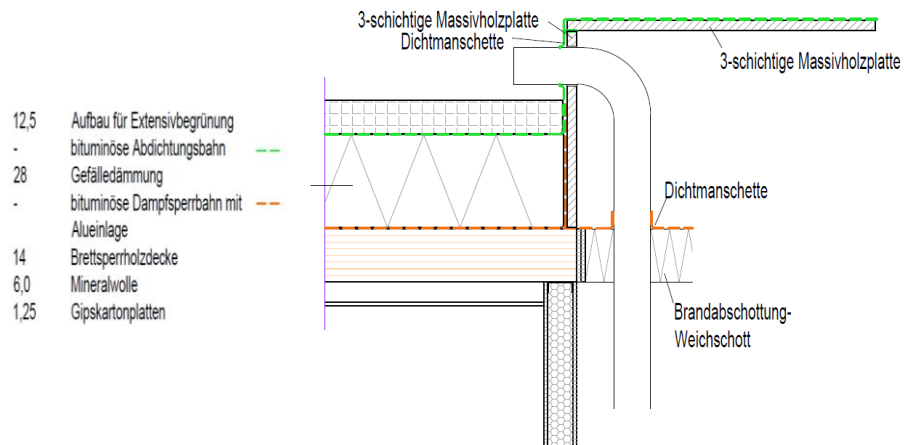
Vertikalschnitt Schachkonstruktion am Dach
